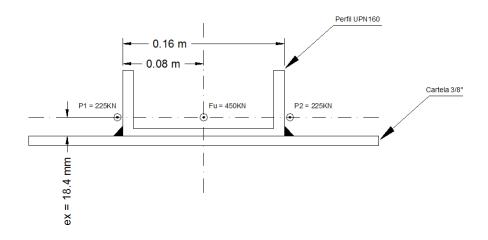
Unión soldada UPN160 con carga excentrica
